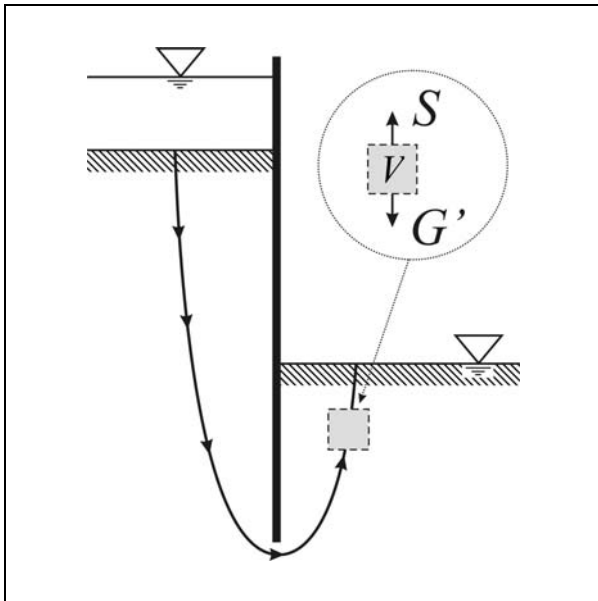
schematische Darstellung des Hydraulischen Grundbruches an einer Baugrubenwand
